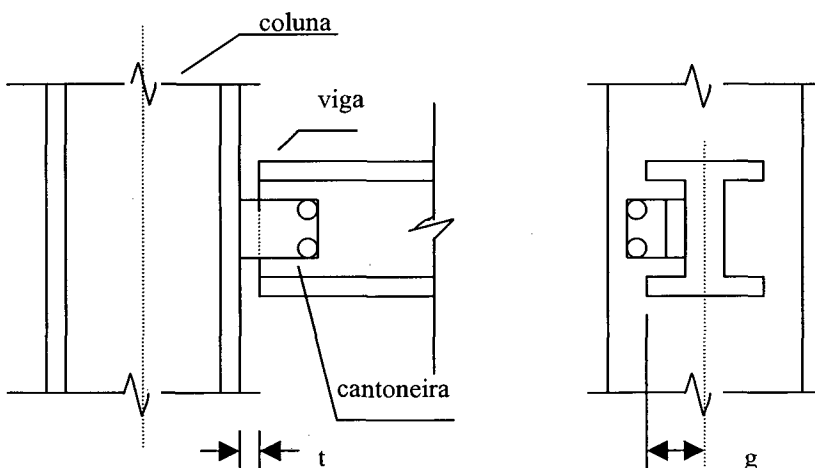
Típica conexão viga-pilar metálica “single web angle”.
